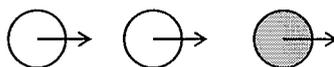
Direzione di applicazione forze orizzontali parallele all'allineamento dei pali
